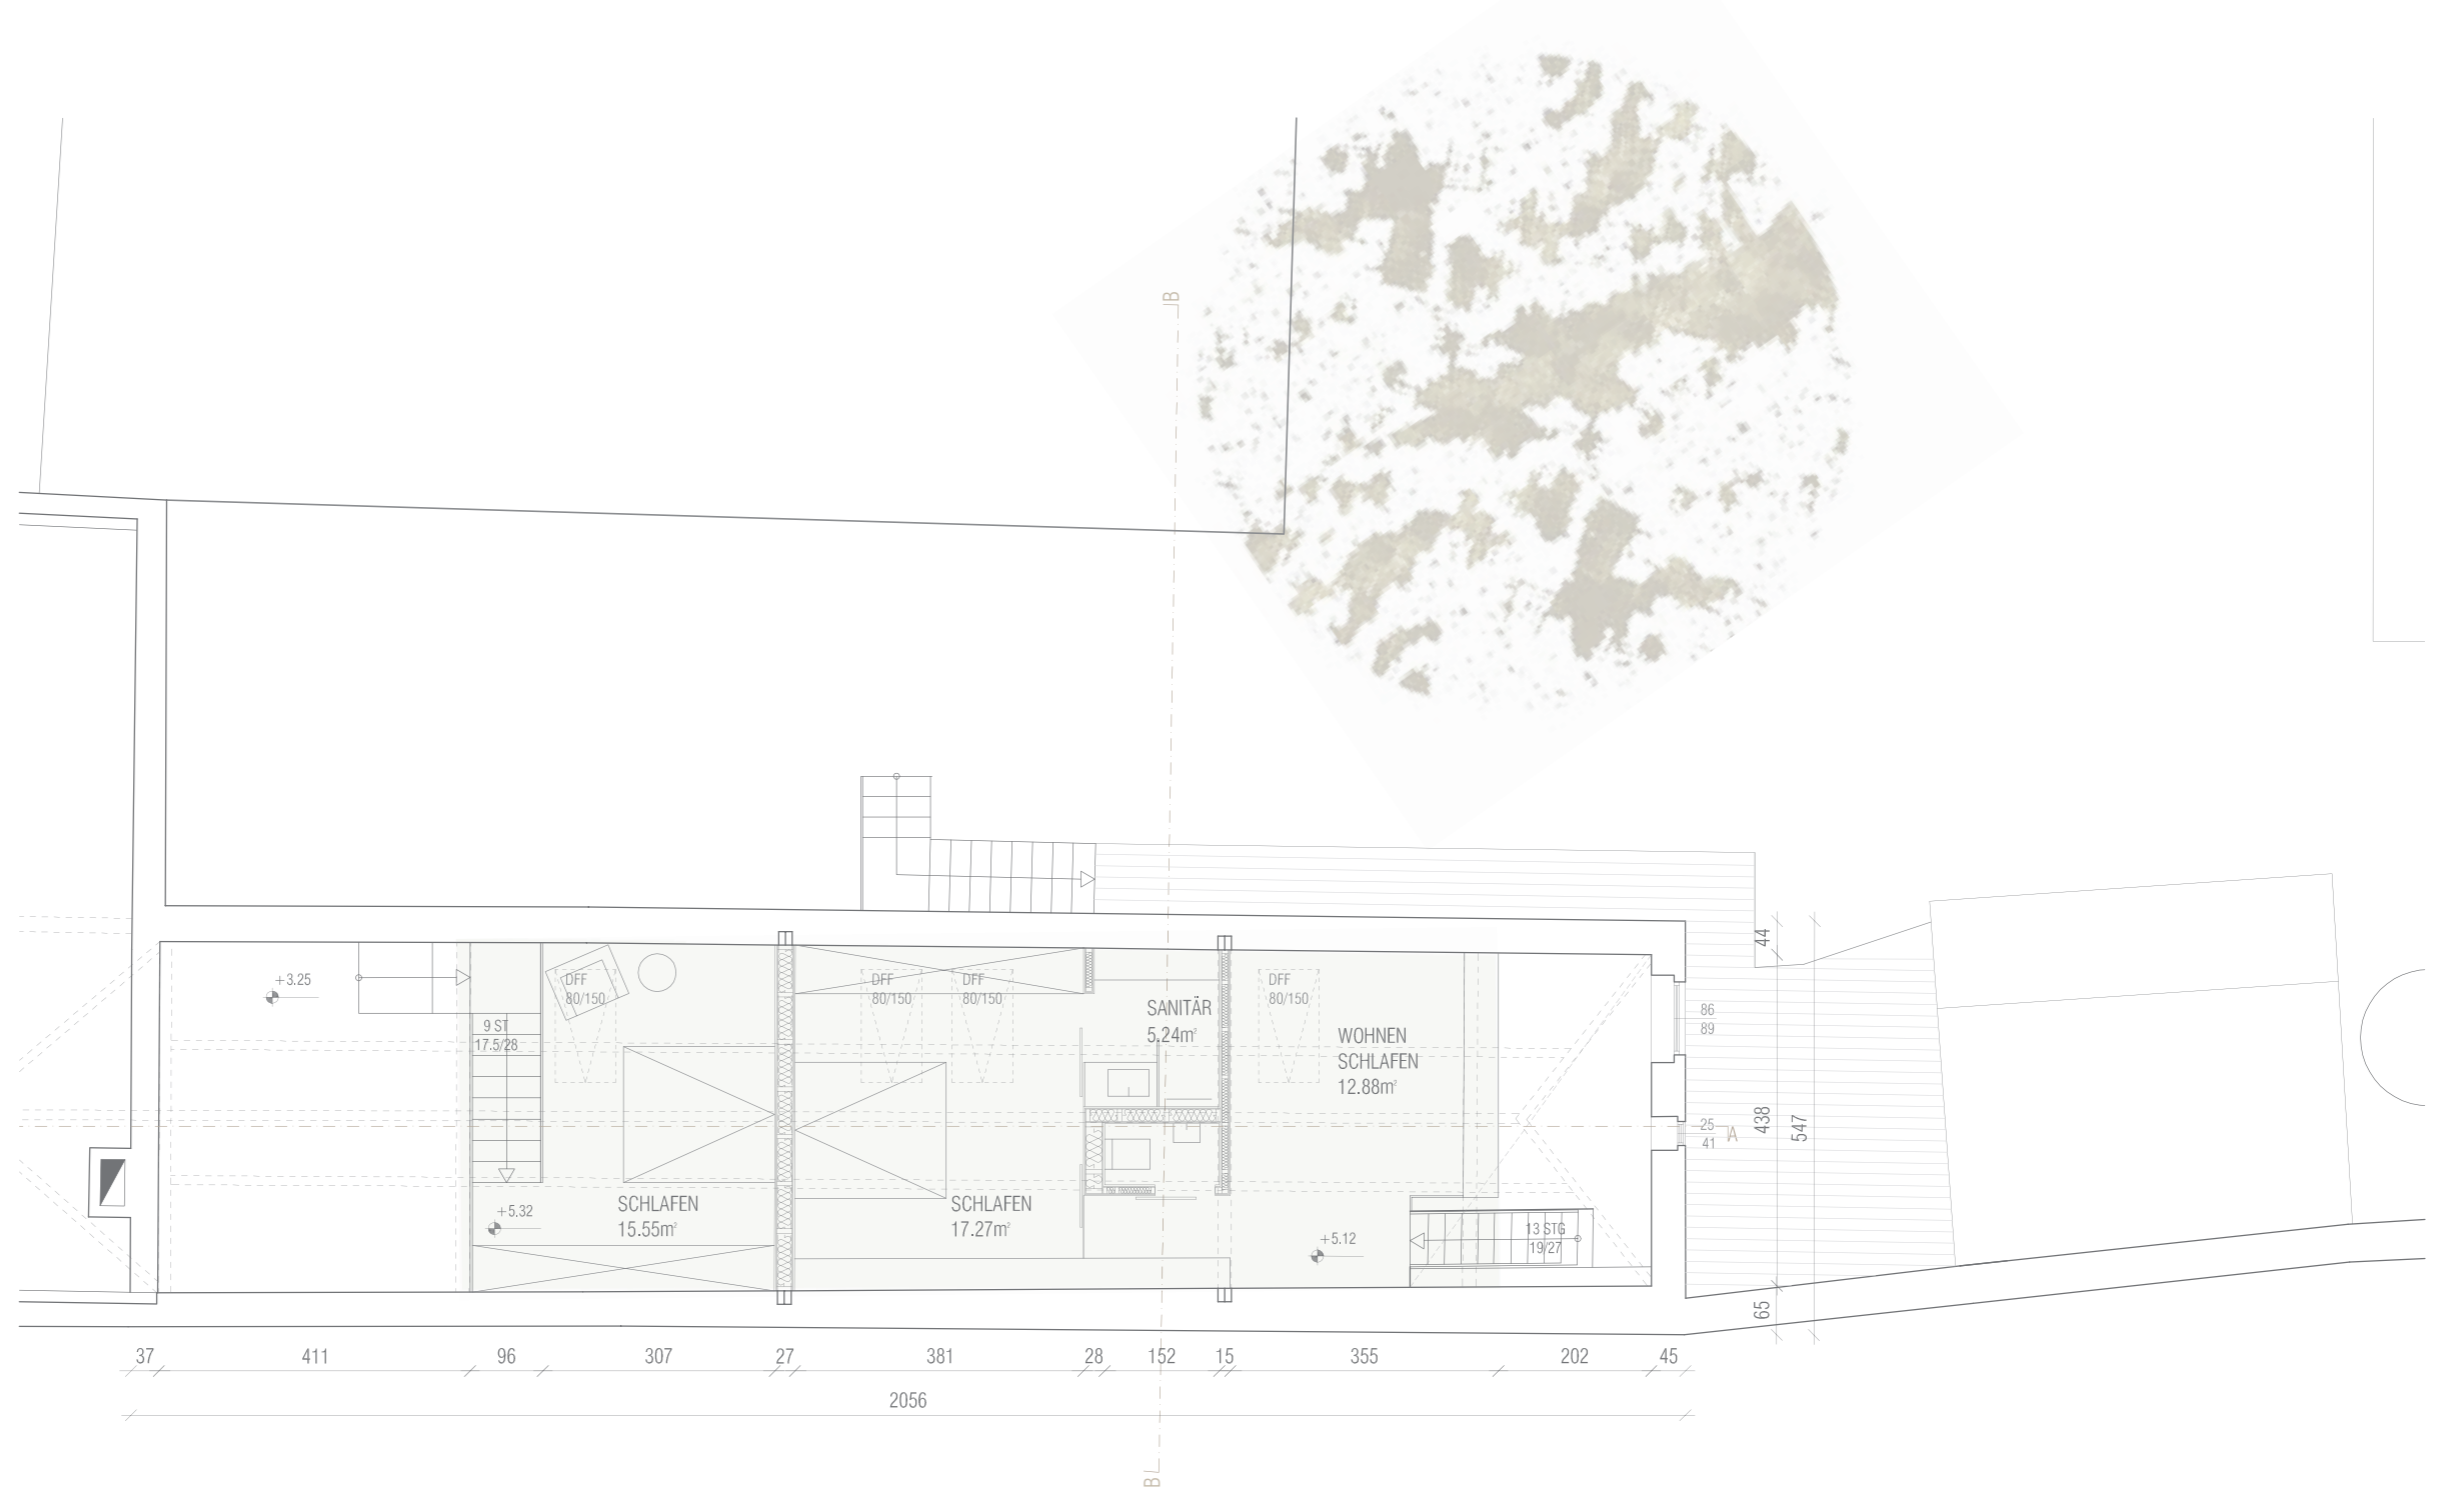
Gebäude A_WOCHENENDHAUS_Grundriss Dachgeschoss Maßstab 1:100
